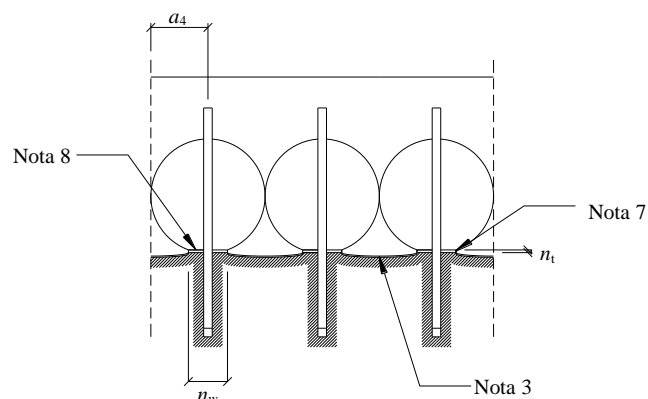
Secção transversal dos aparelhos de apoio (secção AA).
